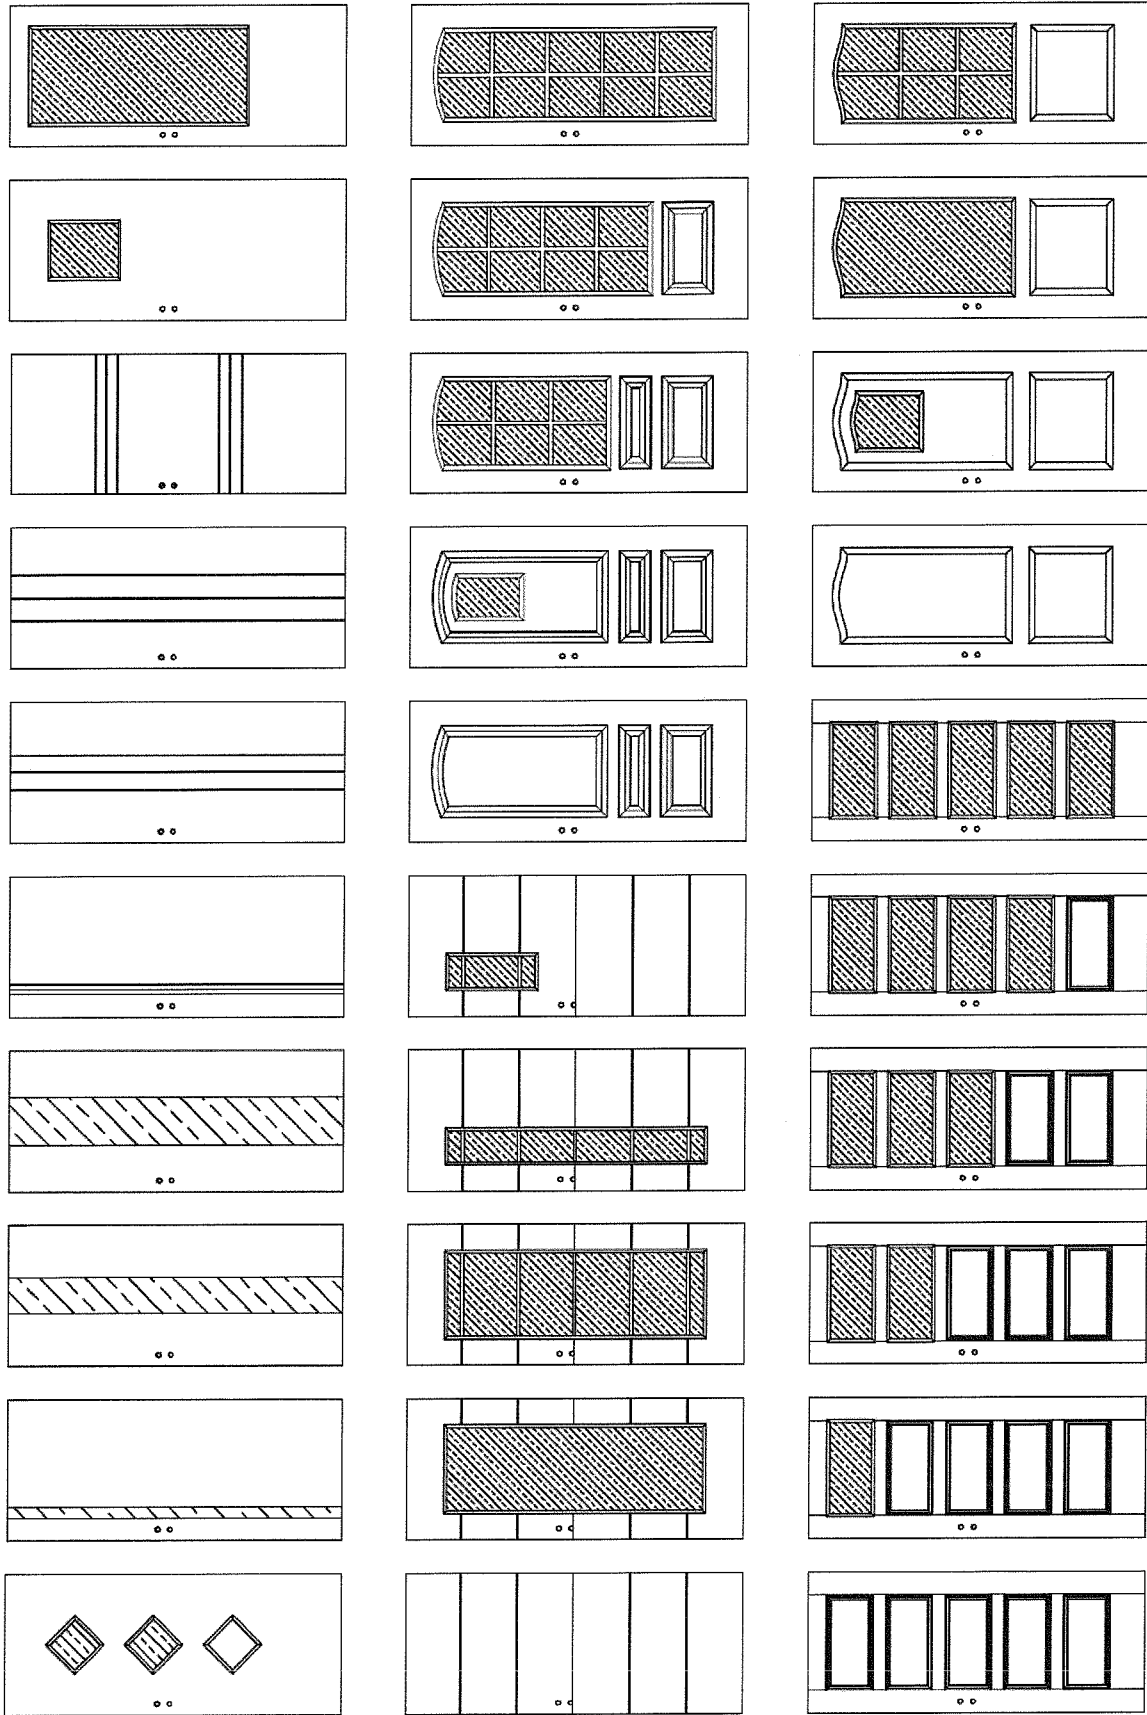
Skrzydło przylgowe o konstrukcji płytowej, z powierzchnią częściowo przeszkloną	42
